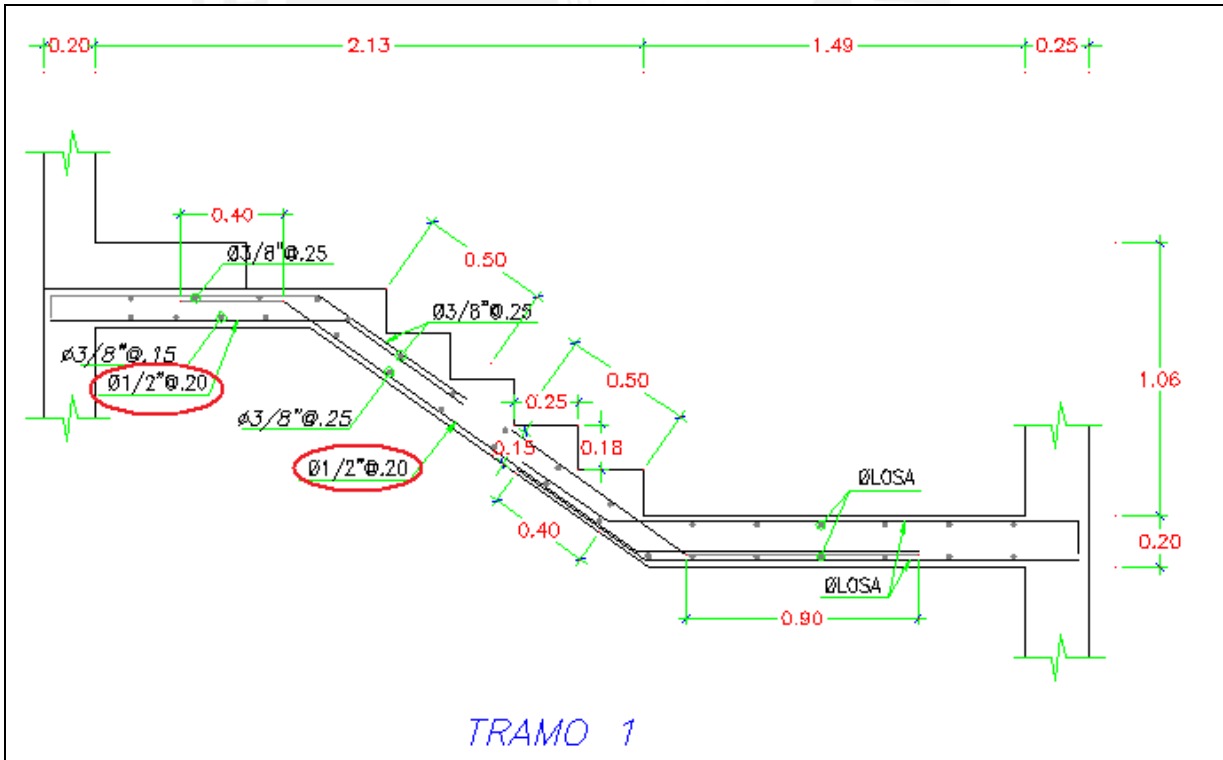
Disposición del acero colocado en el tramo 1 de la escalera E-01.
